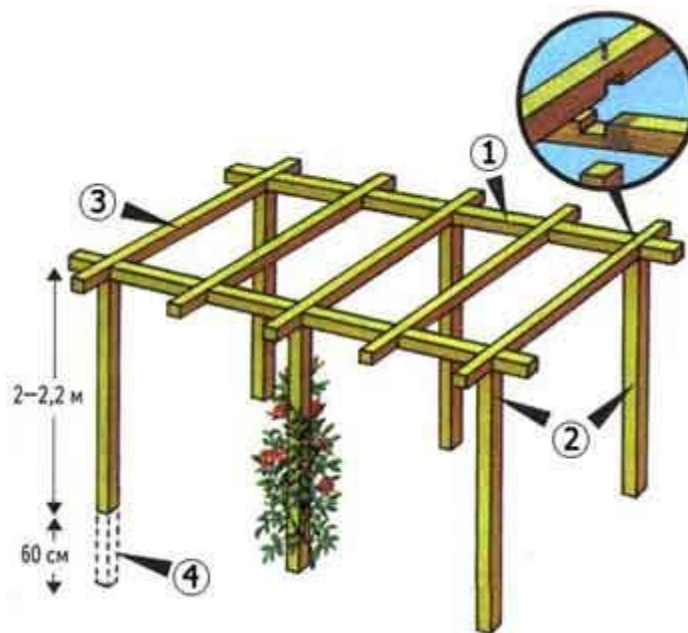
Конструкция перголы: 1 – основные балки, 2 – опоры, 3 – поперечные балки, 4 – фундамент.
